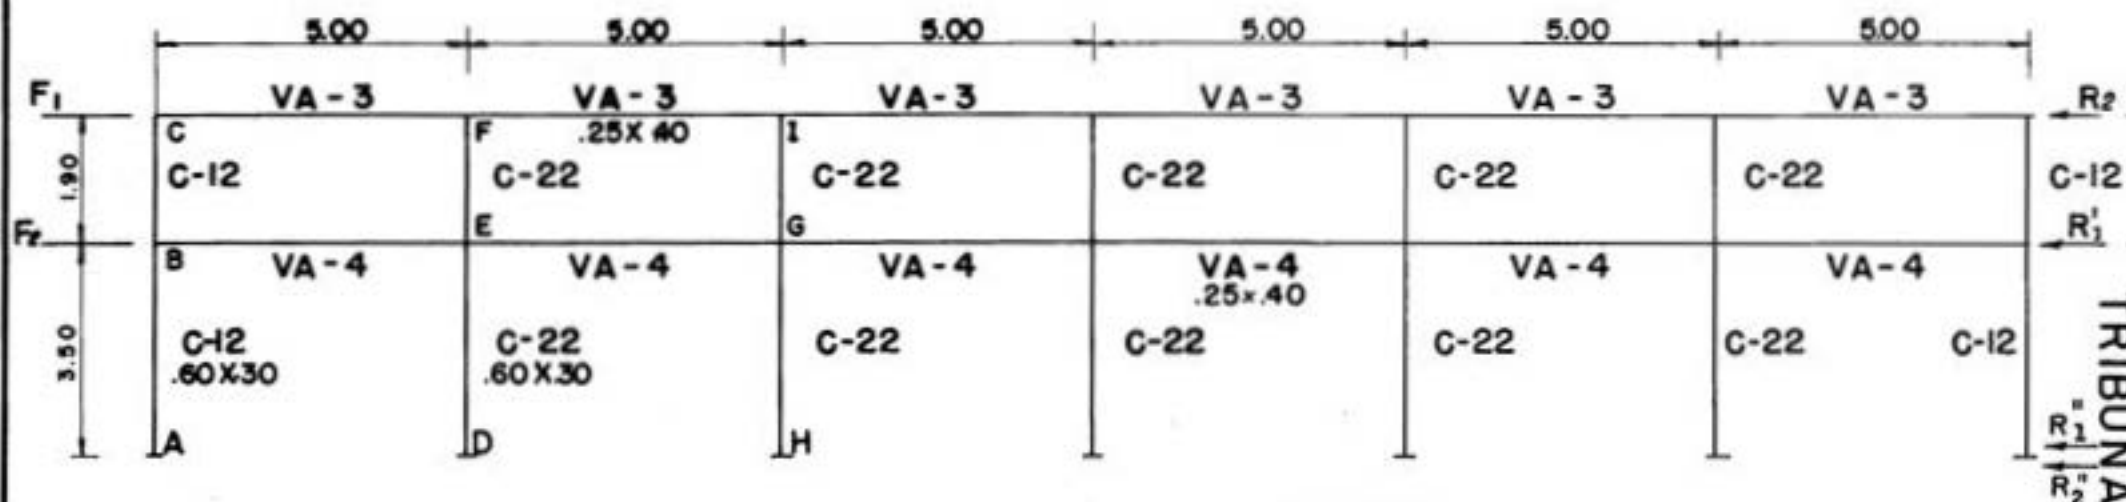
CALCULO DE LAS VIGAS VA-3 Y VA-4 Y ESQUEMA DE EJES Y CARGAS SOBRE EL PORTICO.
